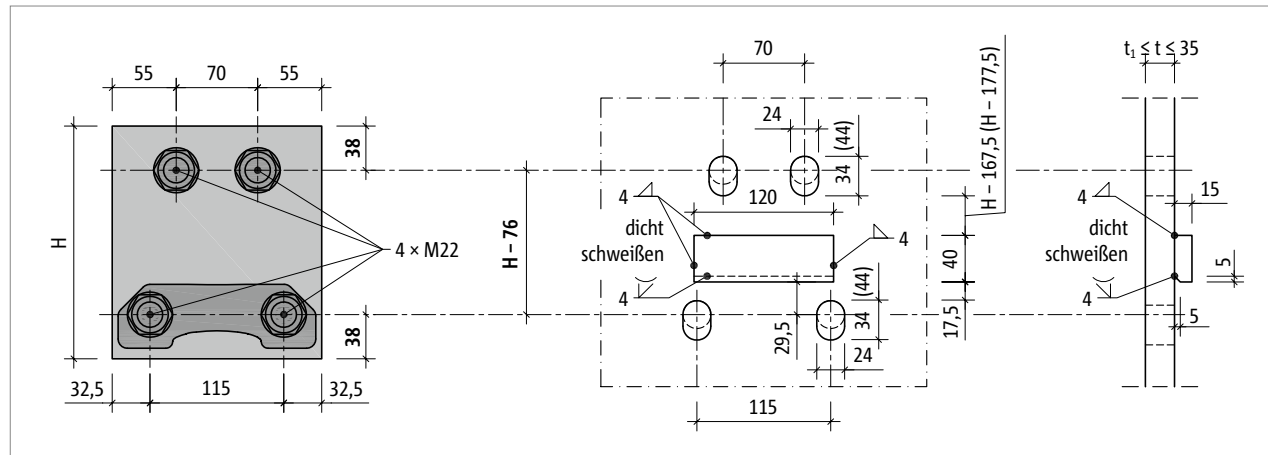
Schöck Isokorb® T Typ SKP-MM2...-CV28: Konstruktion des Stirnplattenanschlusses mit Betondeckung CV28
